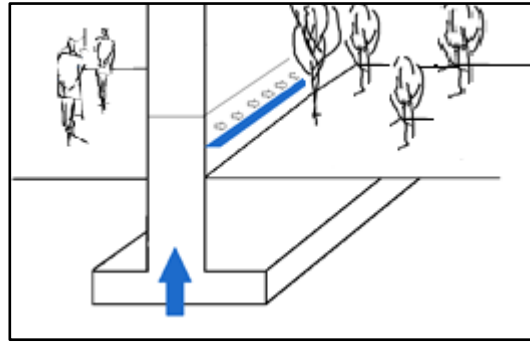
Evaporação pelo pano exterior de parede acima do pavimento.
